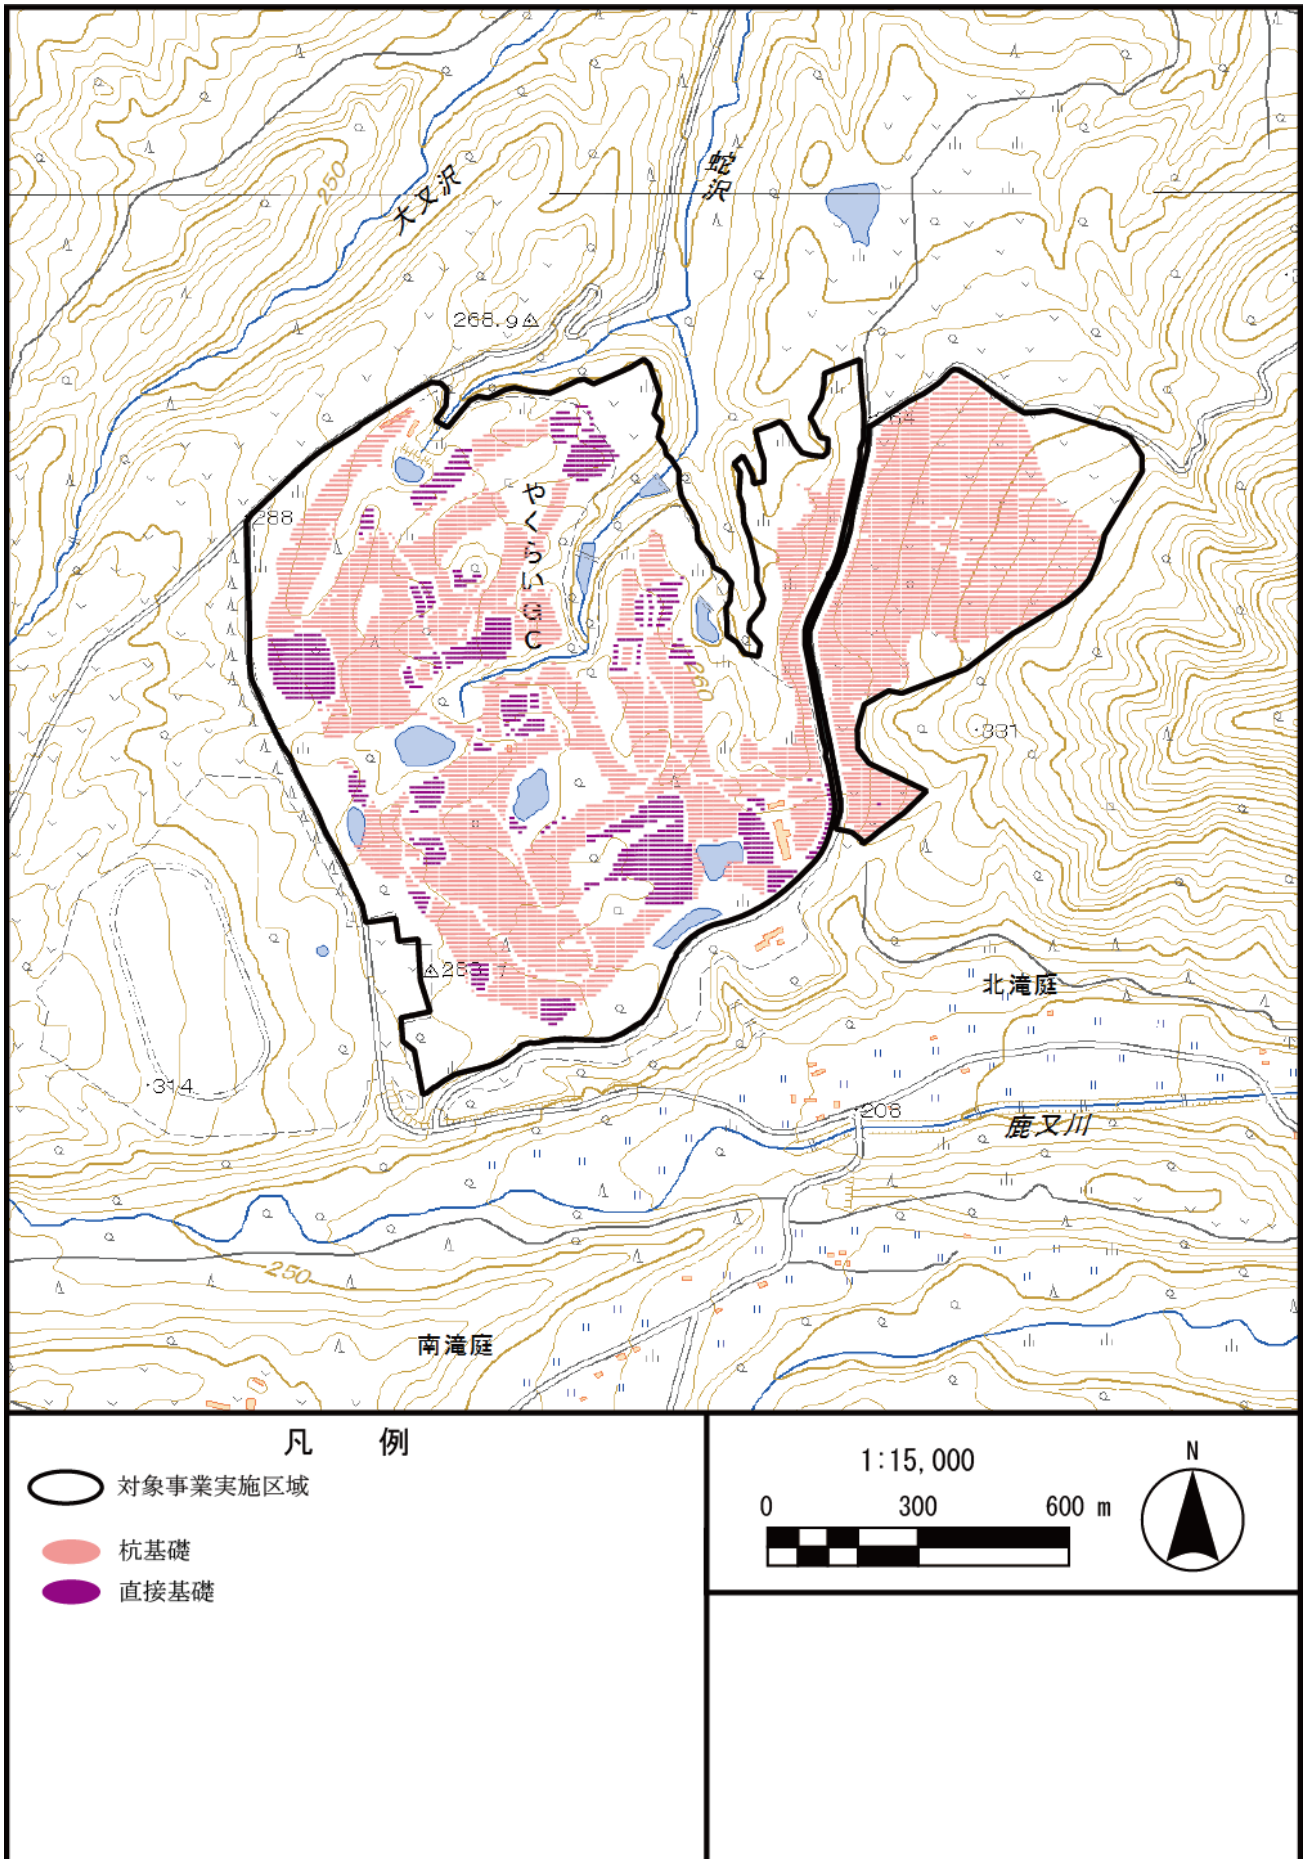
架台基礎タイプ別 太陽光パネル配置図
